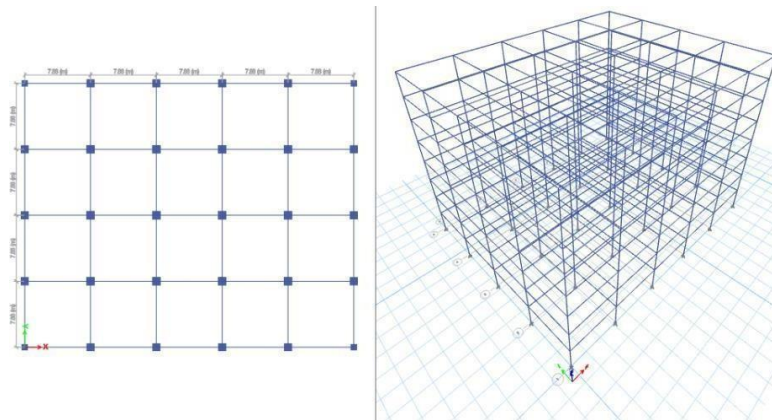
Modelamiento del edificio de 8 pisos, vista de planta y elevación
